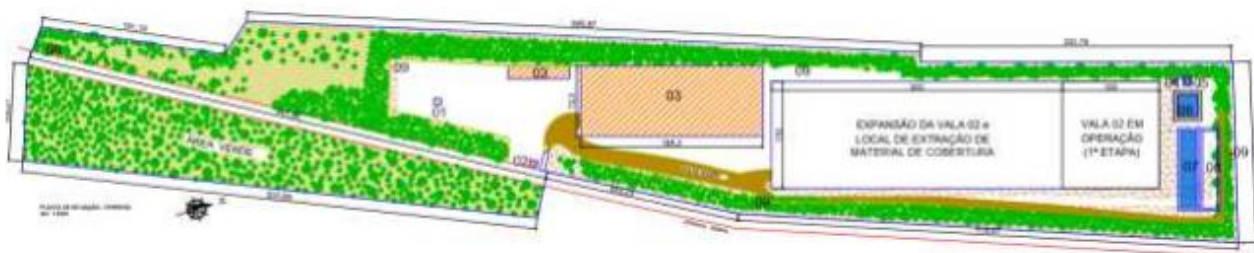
Planta de localização do Aterro Sanitário de Cáceres/MT
